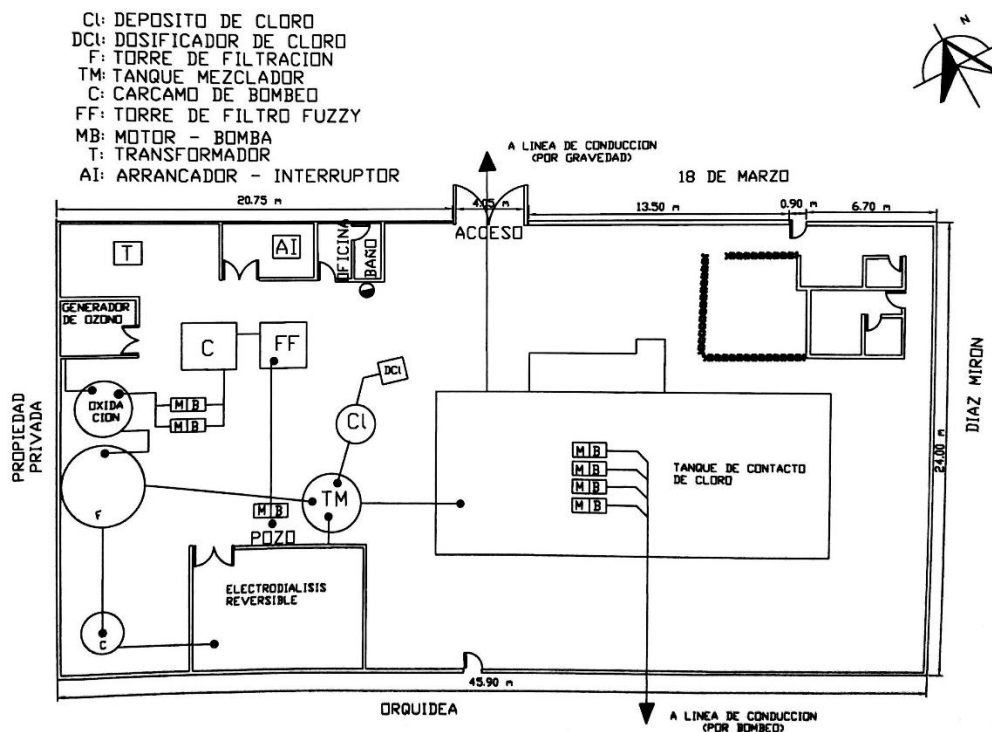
Vista en planta de la PP Purísima Iztapalapa 1
